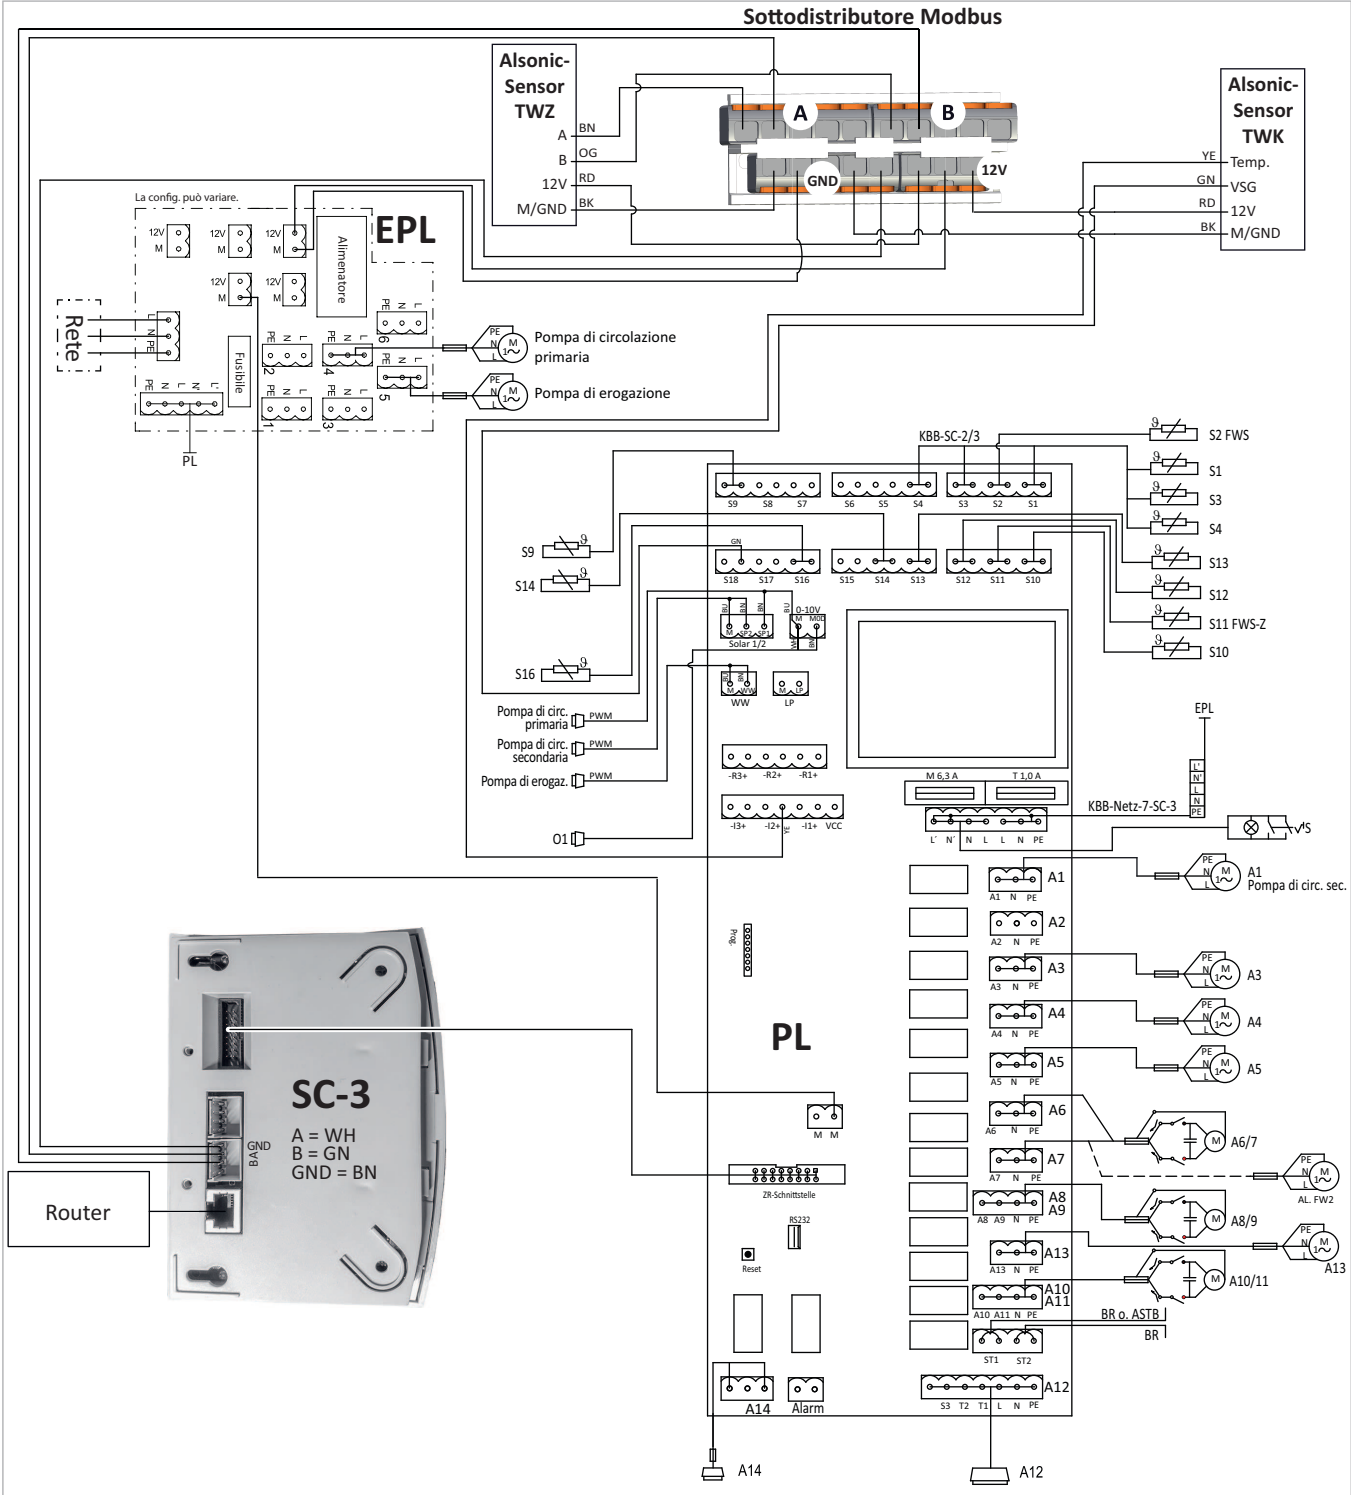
Schema di collegamento del modulo di rete FWS-x
